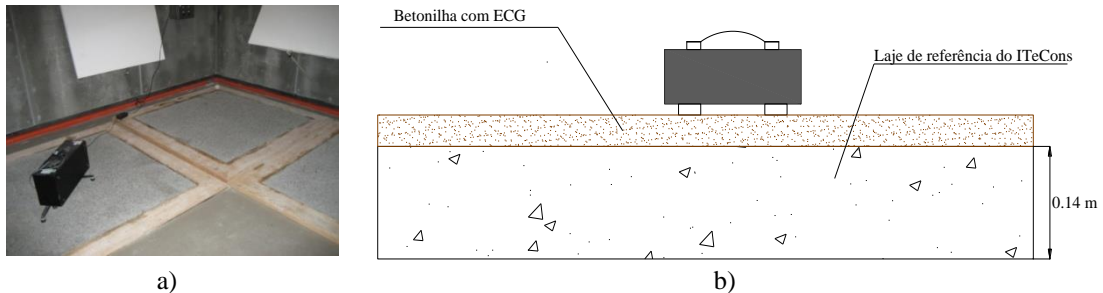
Provete colocado sobre a laje de referência do ITeCons, simulando um sistema de pavimento em que a betonilha leve é aplicada como revestimento aparente (RA): a) Ensaio de percussão no interior da câmara vertical emissora; b) Representação esquemática.
